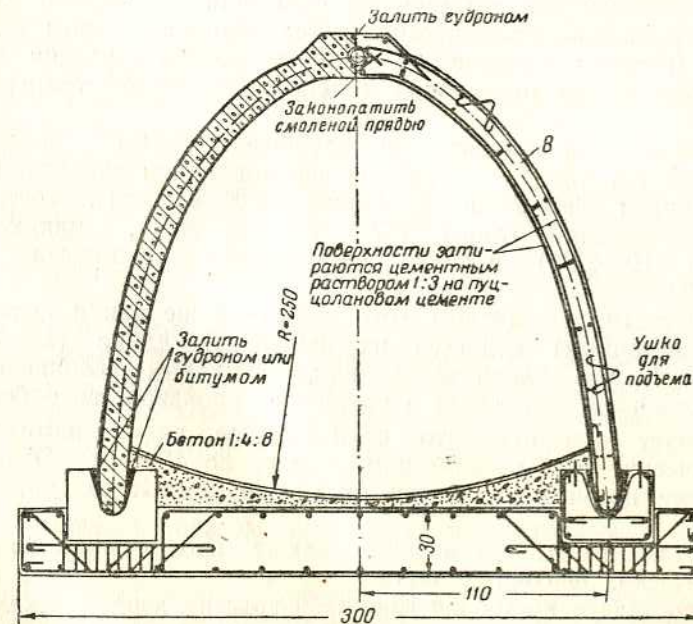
Железобетонный канал шатрового сечения, сборной конструкции
